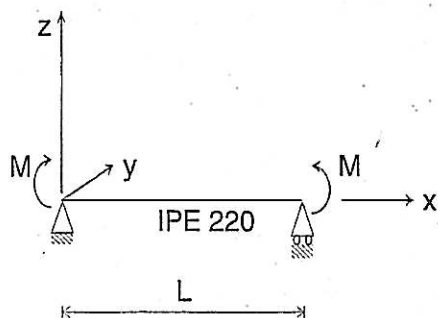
Viga tridimensional simplesmente apoiada, sujeita a momentos nas extremidades.
